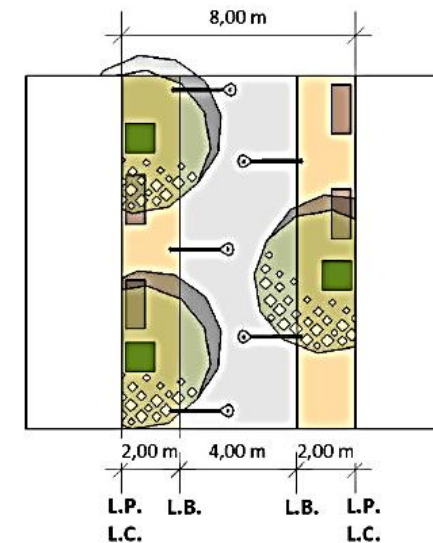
Planta y Corte Vía Peatonal propuesta. Equipo Asesor PP.
